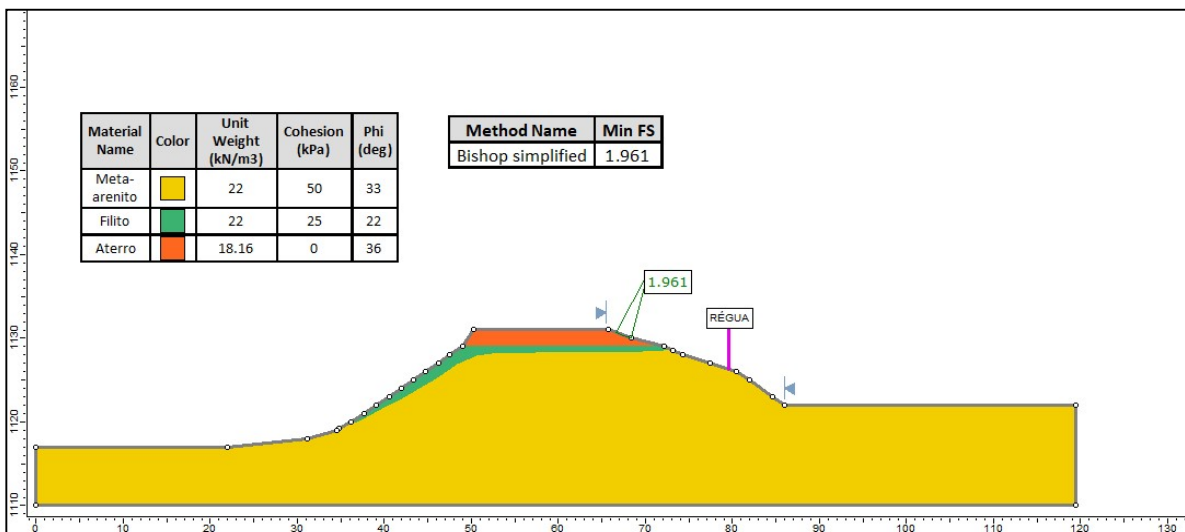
Fase final de construção – Bishop Simplificado – Montante – Local.
